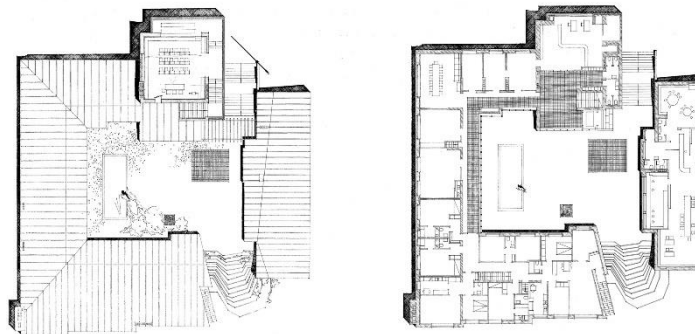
PLANO DE CUBIERTA Y DE PLANTA BAJA AYUNTAMIENTO SÄYNÄTSALO . FUENTE:
